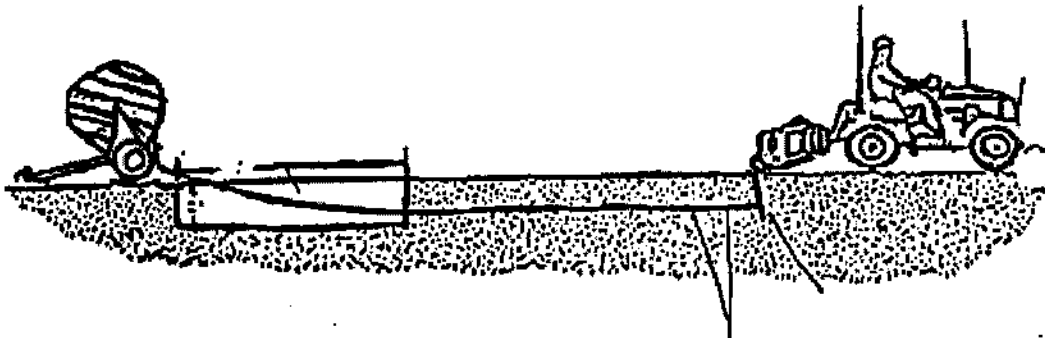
Instalação de cabo óptico encapsulado utilizando o método "Plow Pull".
